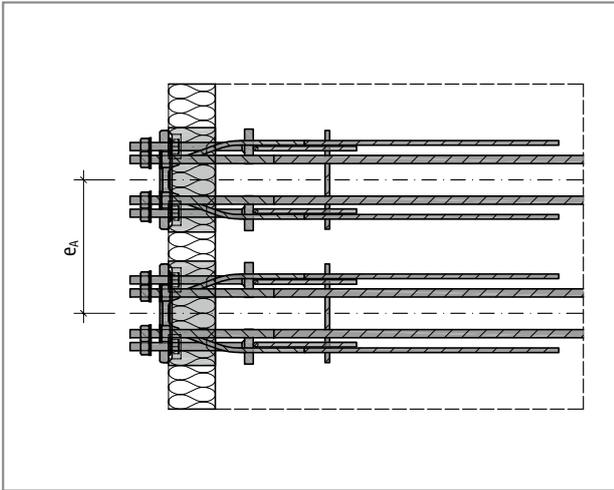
Schöck Isokorb® T type SK : Entraxe
